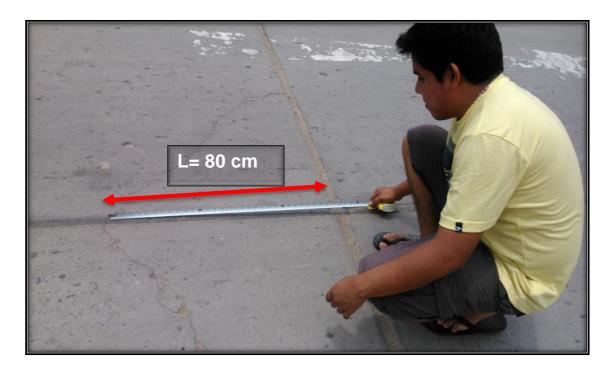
Grieta de Esquina presente en el pavimento, tomando su respectiva longitud vertical vista en la foto.
